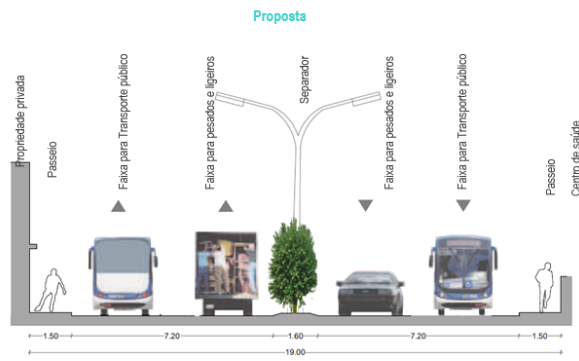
Proposta de Perfil para vias Primárias com separador central
